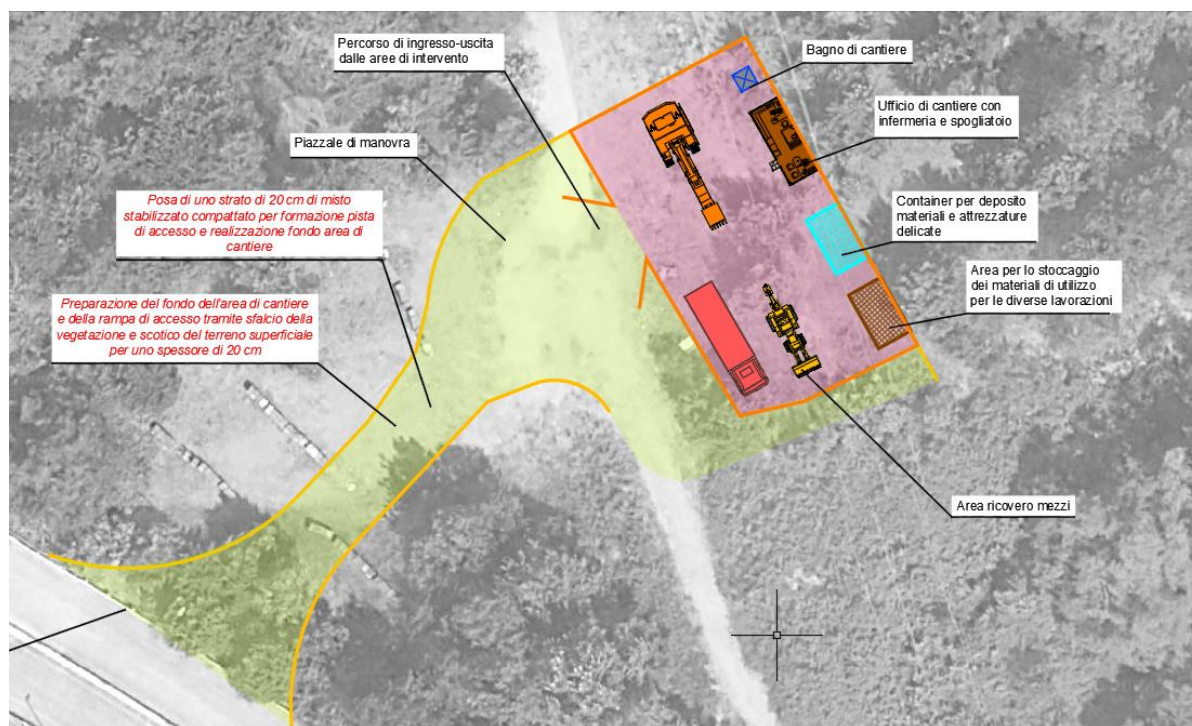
PLANIMETRIA UBICAZIONE CANTIERE
